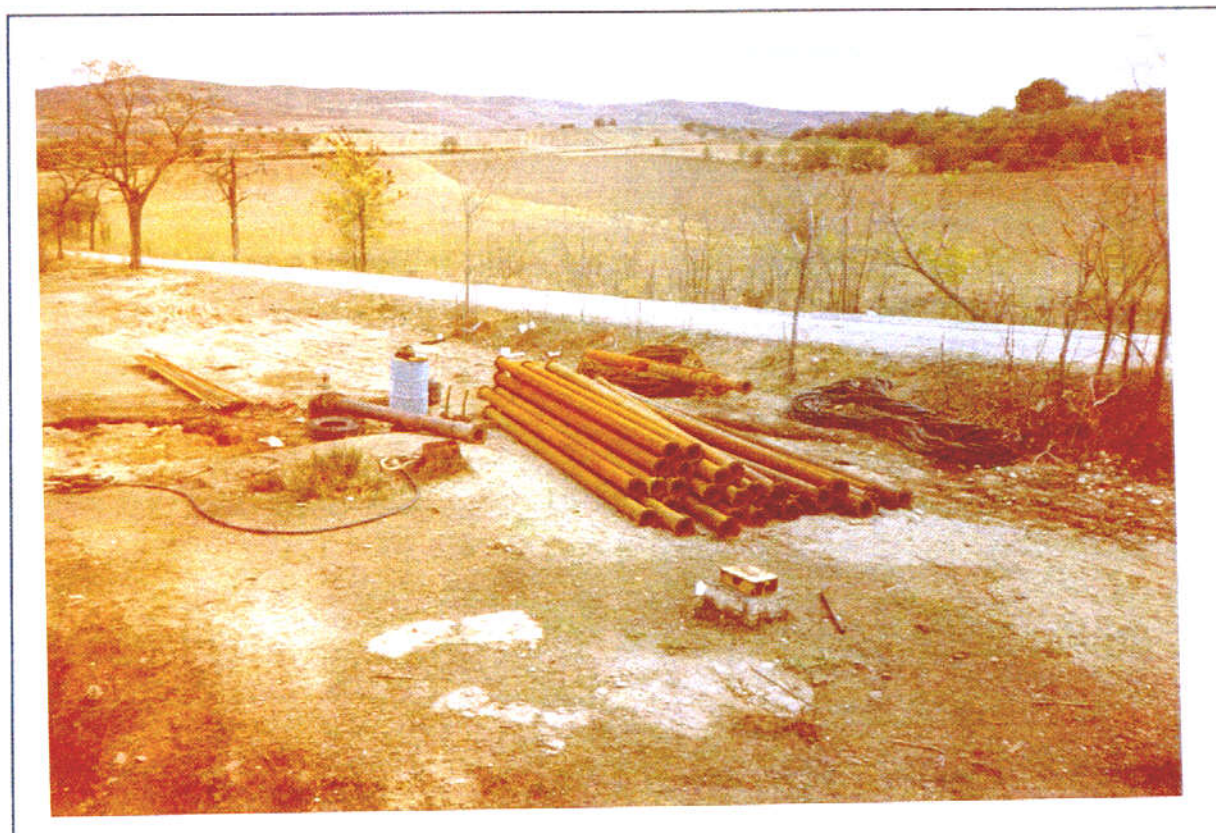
Vista del piezómetro situado un poco más arriba del sondeo.
